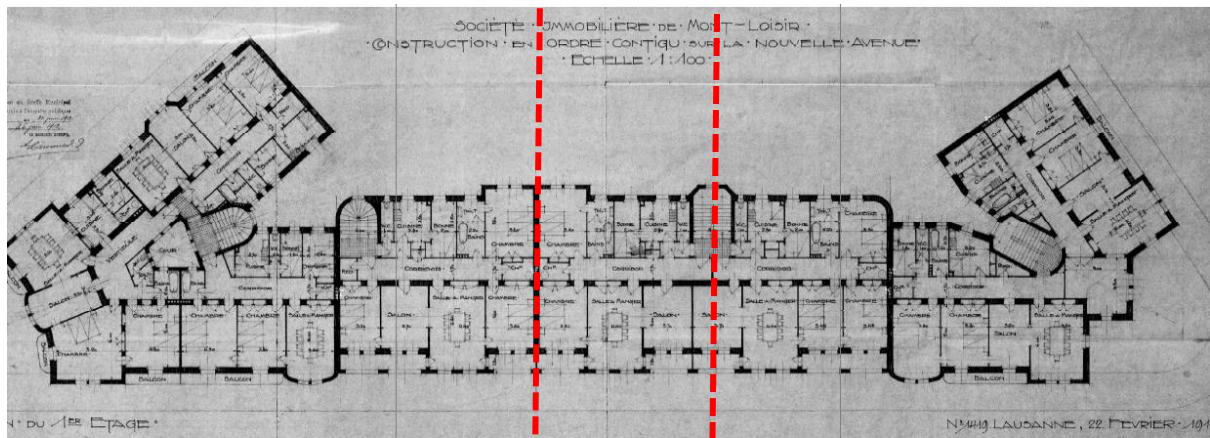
Bâtiment Av. Mon-Loisir 11, 13 – Plans d'enquête – Plan de 1<sup>er</sup> Etage
